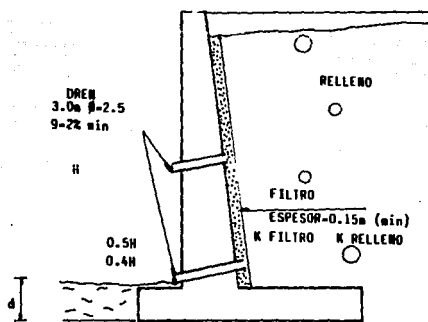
SISTEMA DE DRENAJE PARA MURO
